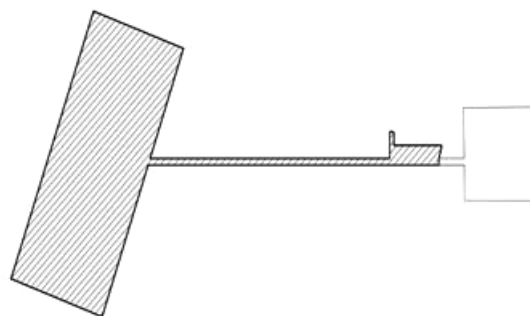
TGNL - Destaque do projeto para a área pretendida em mar. Fonte: LC Terminais (2025).
